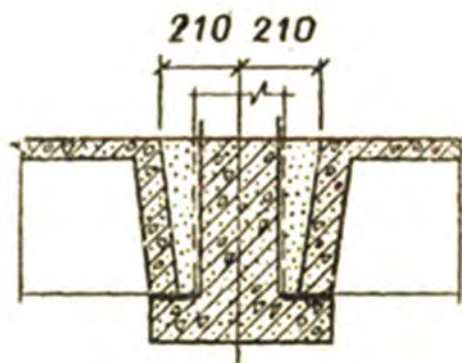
Деталь опирания перекрытия на нижний пояс безраскосных ферм
